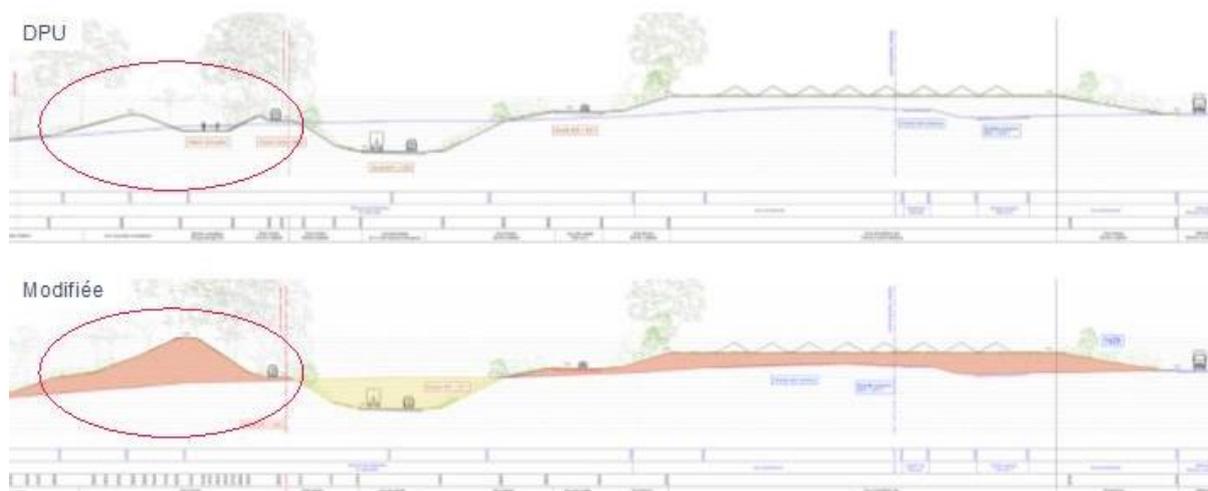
coupe du nouveau merlon paysager (source : ASSAR)
